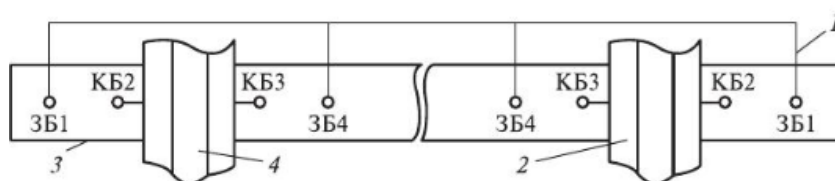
Электрическая схема конструкции железобетонных шпал:
